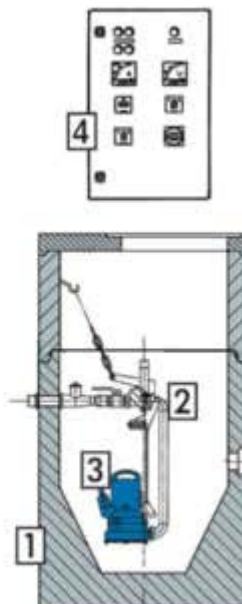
Beton-Fertigschacht DN 1000 (BFS 1000), Einbaubeispiel mit nass aufgestellter Pumpe PIRANHA
